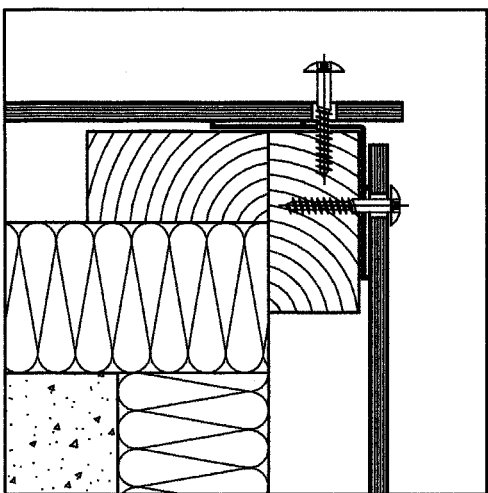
buitenhoek (horizontale doorsnede)
